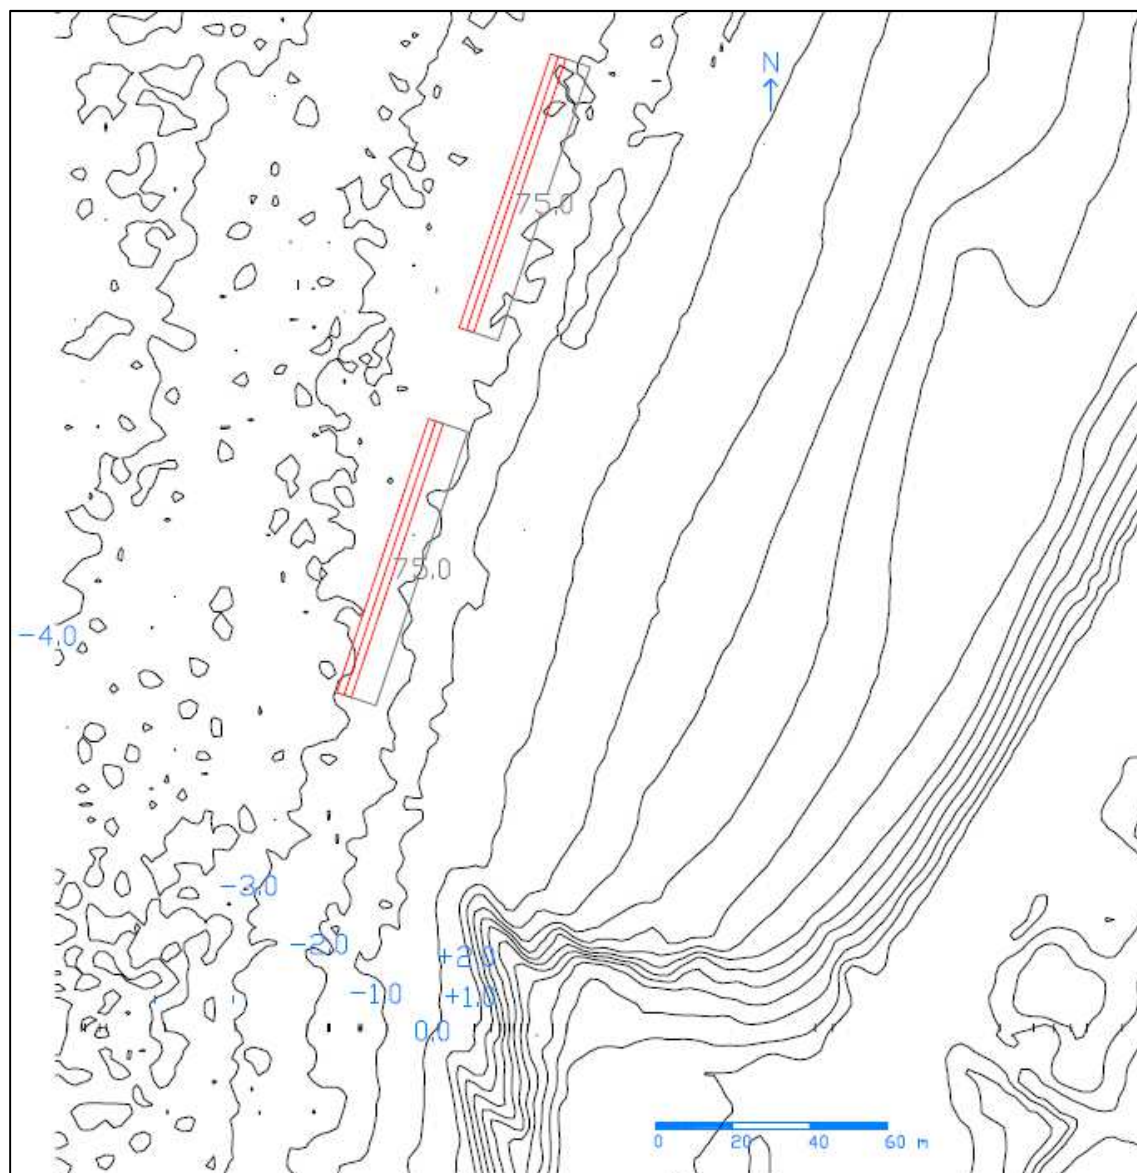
Planta de implantação de quebramar destacado descontínuo (dois módulos) com 150 m de comprimento (2 x 75 m)
